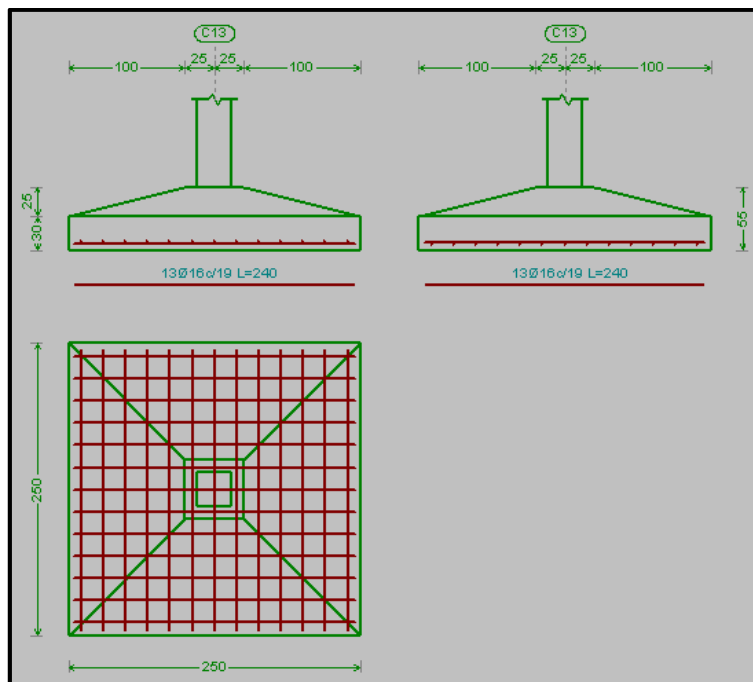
Armado de la Zapata C13 (Fuente: CYPECAD 2014)
